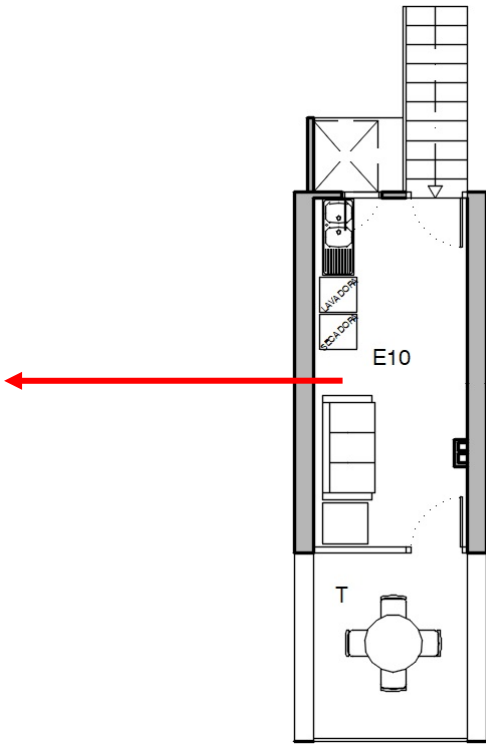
Distribución Planta 3º / Imágenes 3D
